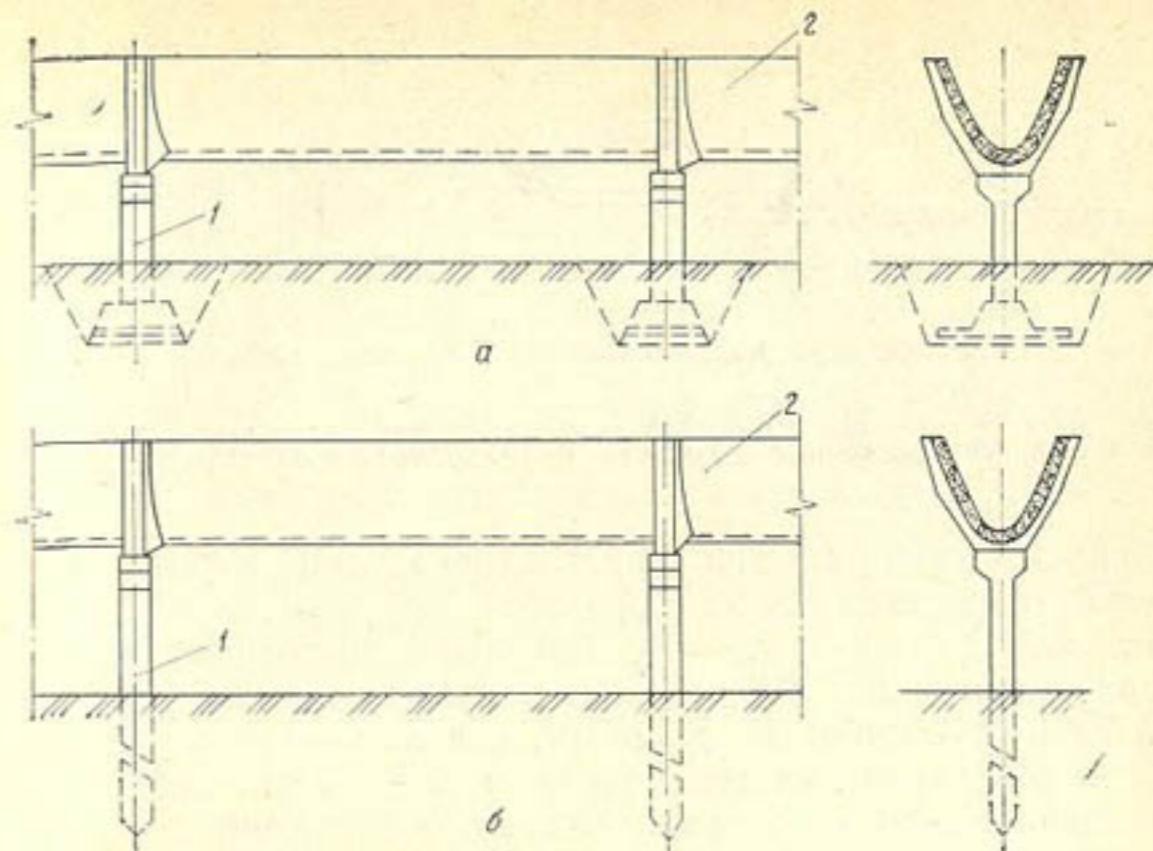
Лотковые каналы на стойках с опорными плитами (а) и на сваях-стойках (б):
